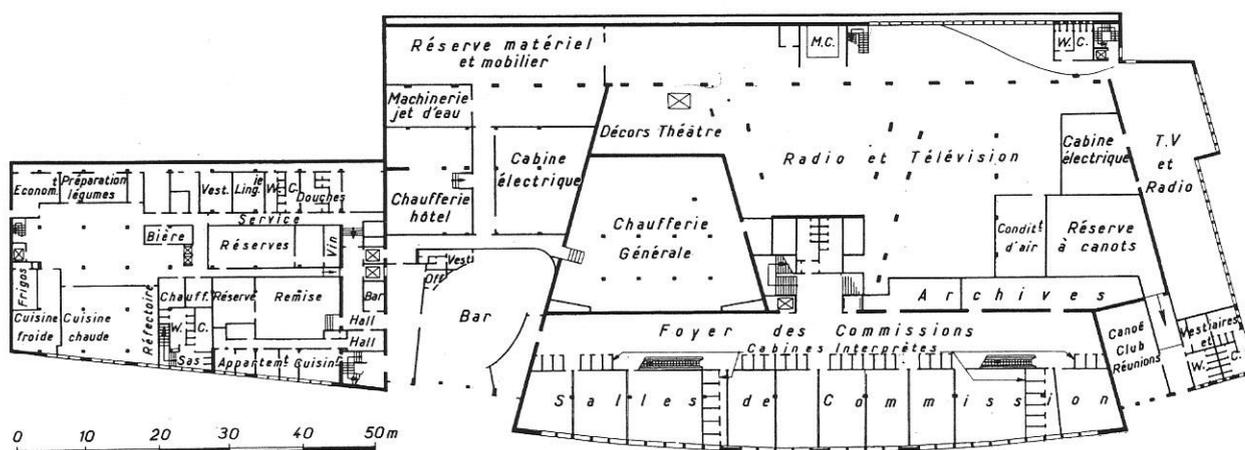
PLAN DU SOUS-SOL (niveau quai).
